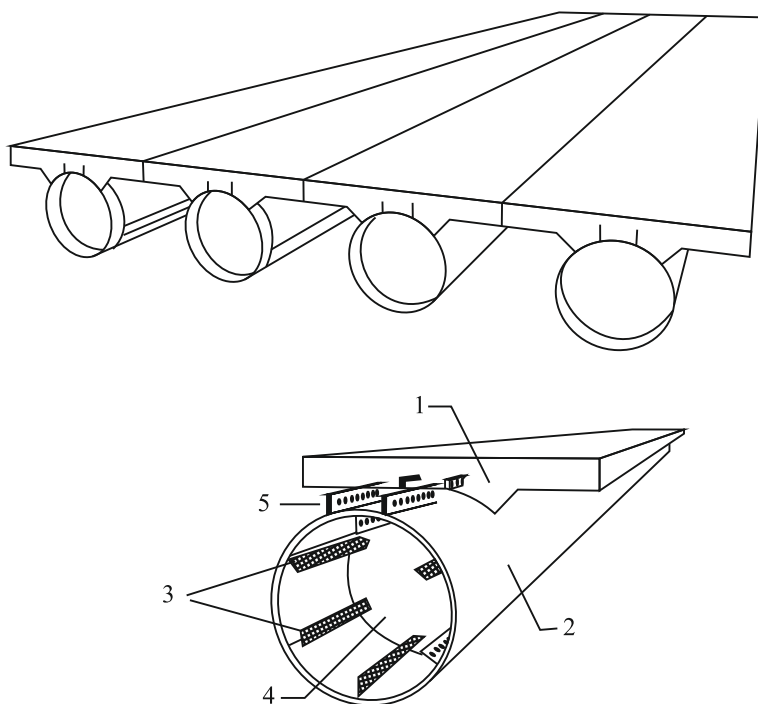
Автодорожные мосты с трубобетонным верхним поясом (а) и трубобетонными подпругами (б) [2]
